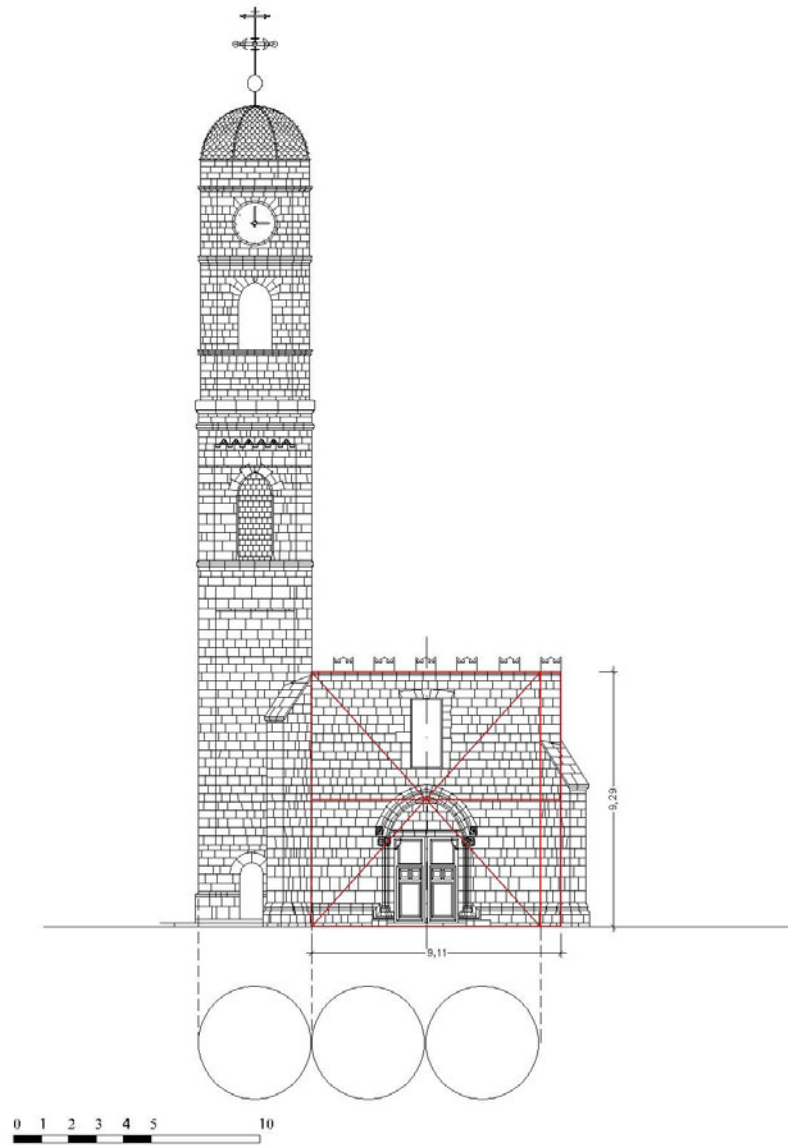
Prospetto della chiesa di San Pietro ad Assemini (CA).
